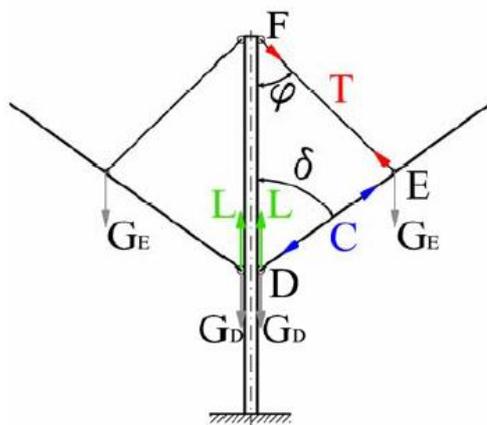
Gleichgewicht der Kräfte beim Hubvorgang - Zugstrebenvariante
